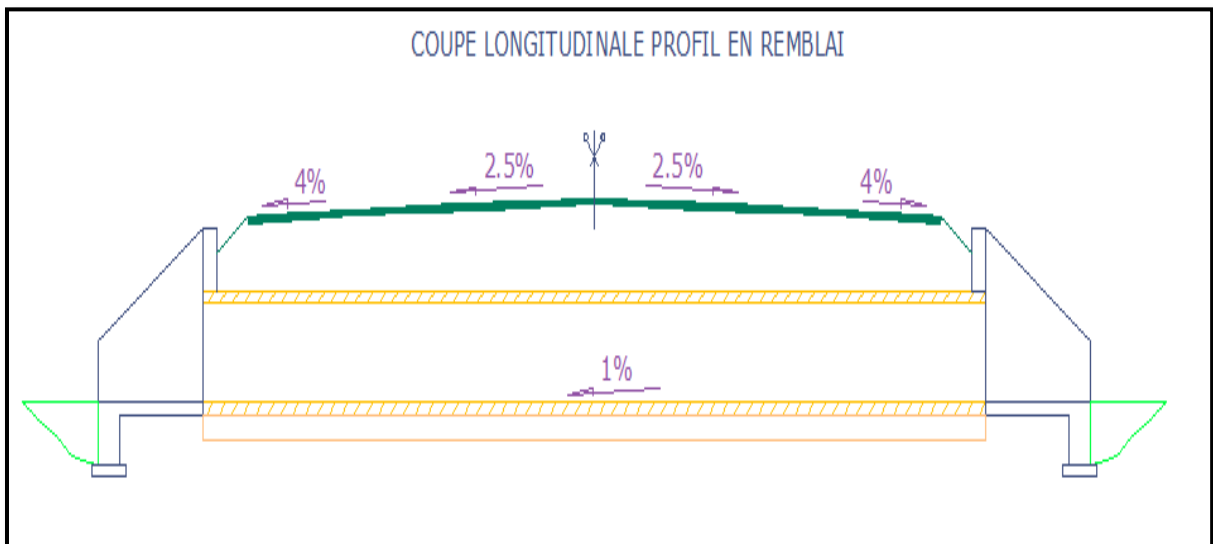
8:profil en travers sur ouvrage busé en remblai.
